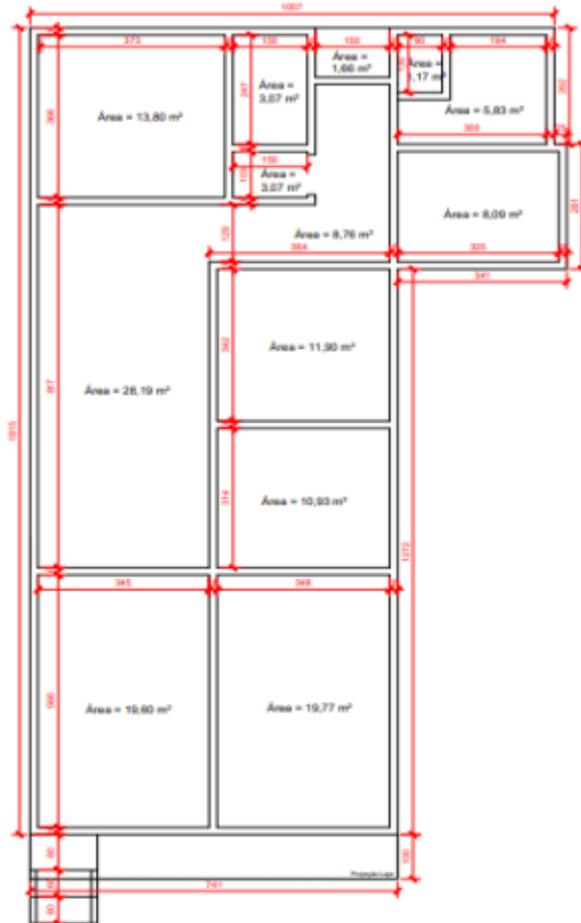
Planta baixa de localização com cotas da Fundação Educacional Joanna De Angelis.
